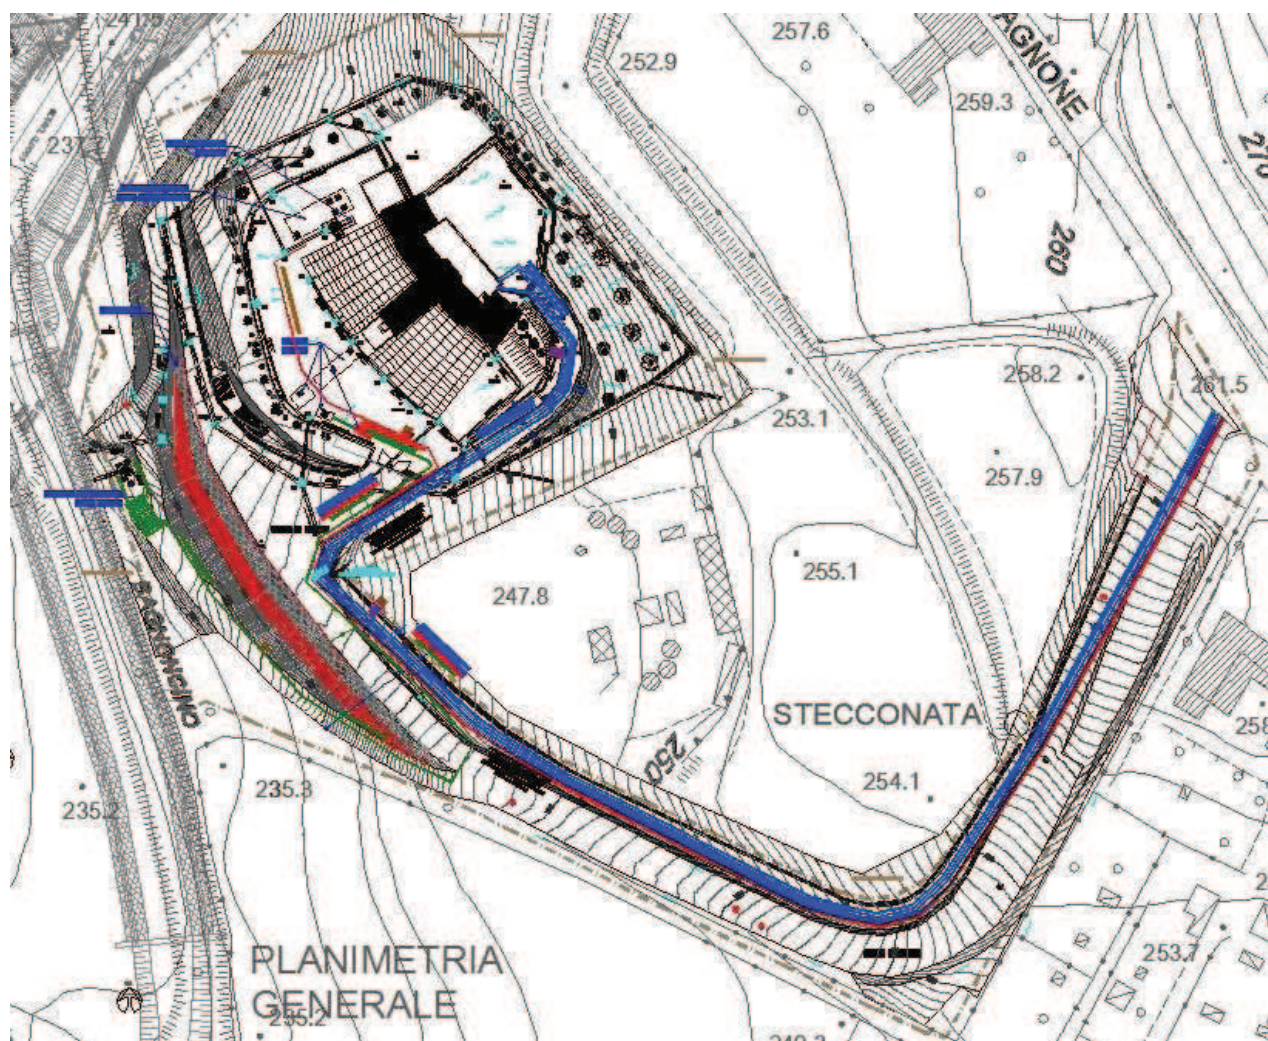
Planimetria reti idriche/fognarie nell'area della nuova centrale fino all'immissione sulla S.P. n°42
